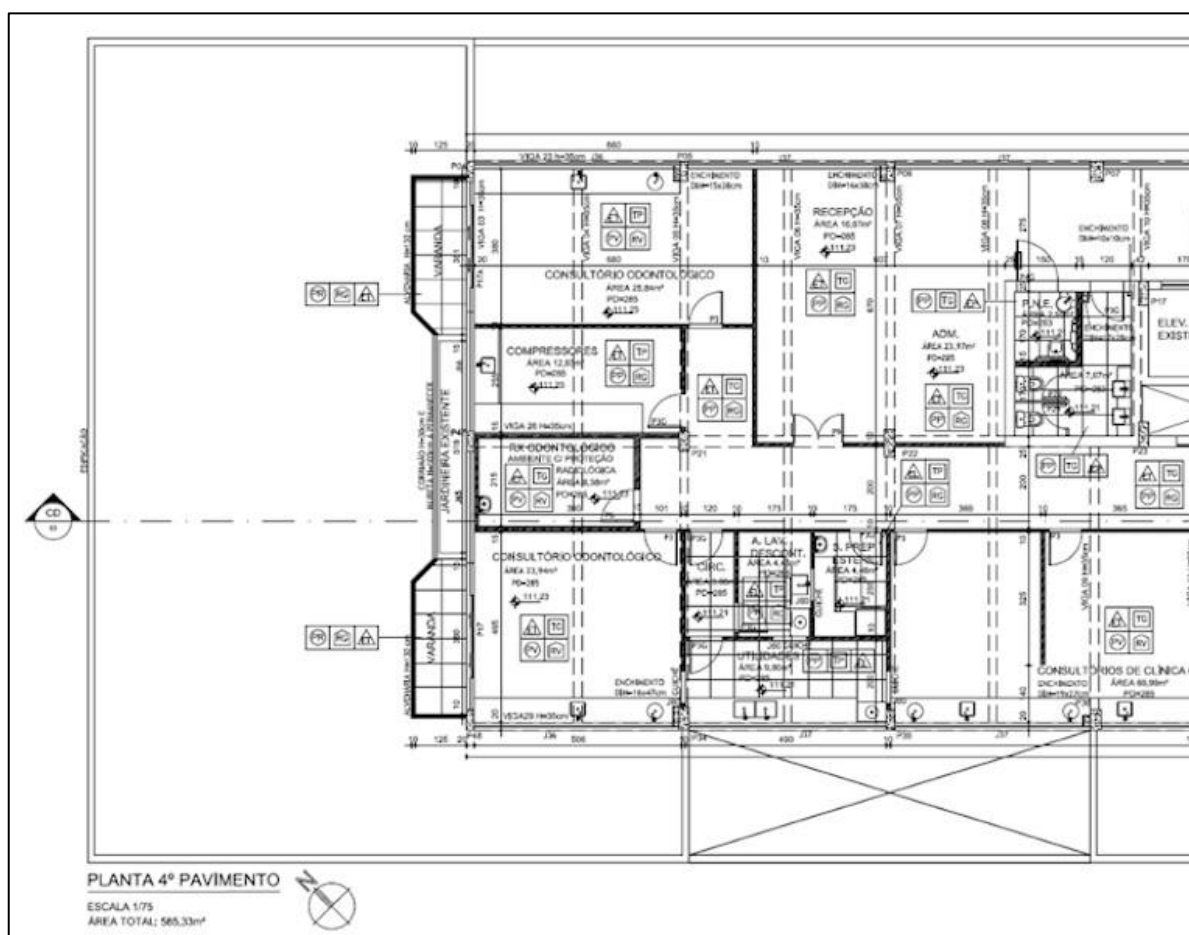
Planta 4º pavimento - manutenção das varandas na fachada frontal.
